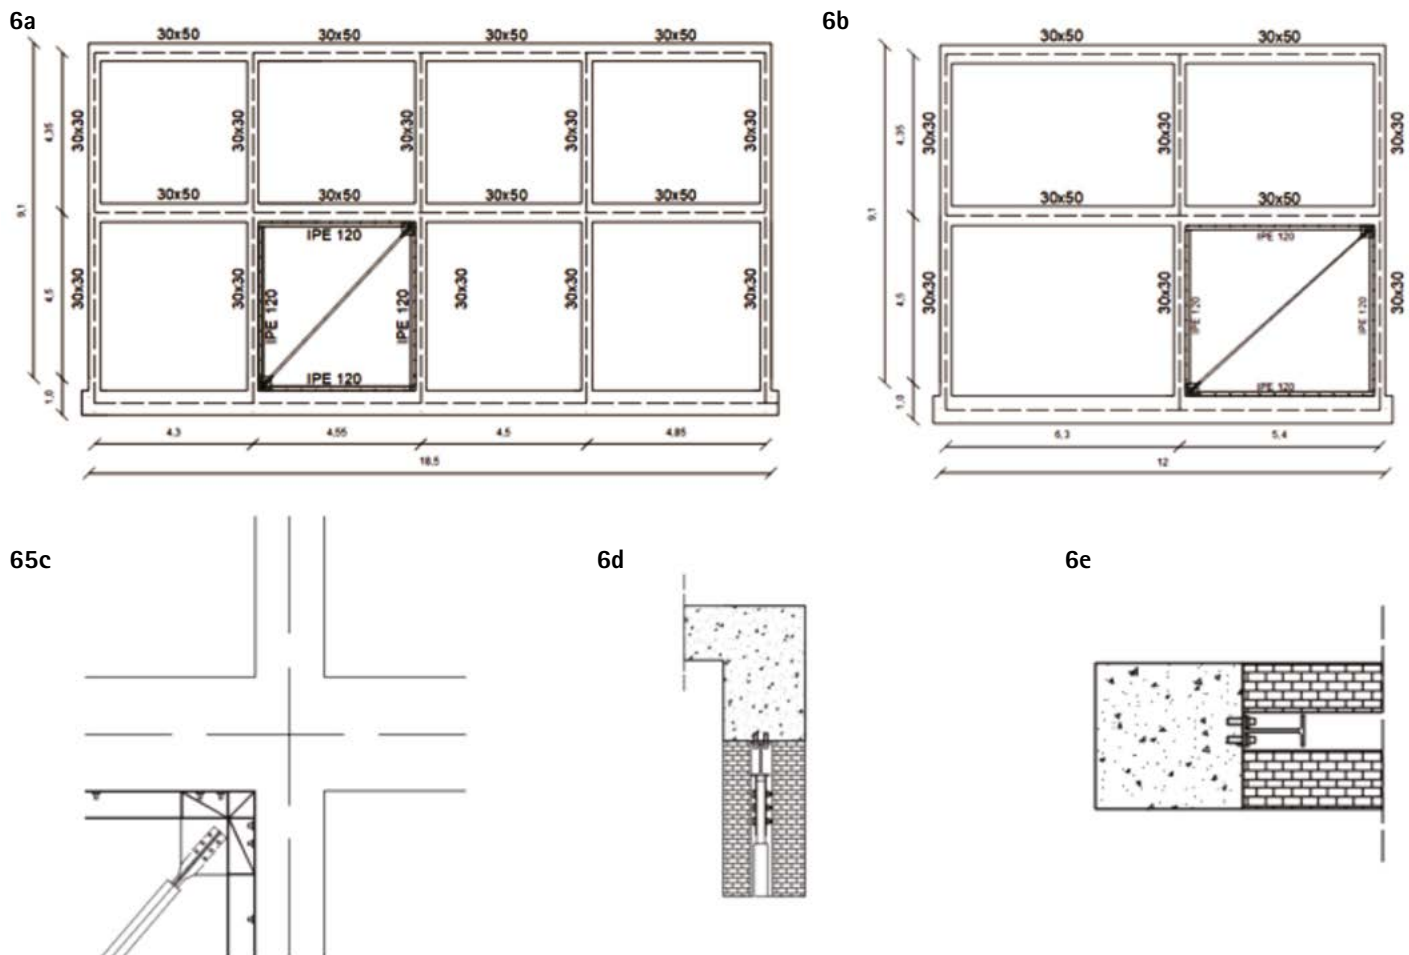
a) posizionamento del telaio in acciaio controventato in direzione longitudinale; b) posizionamento del telaio in acciaio controventato in direzione trasversale; c) particolare del nodo trave-pilastro-BRB; d) particolare del collegamento IPE120-trave in c.a.; e) particolare del collegamento IPE120-pilastro in c.a.
